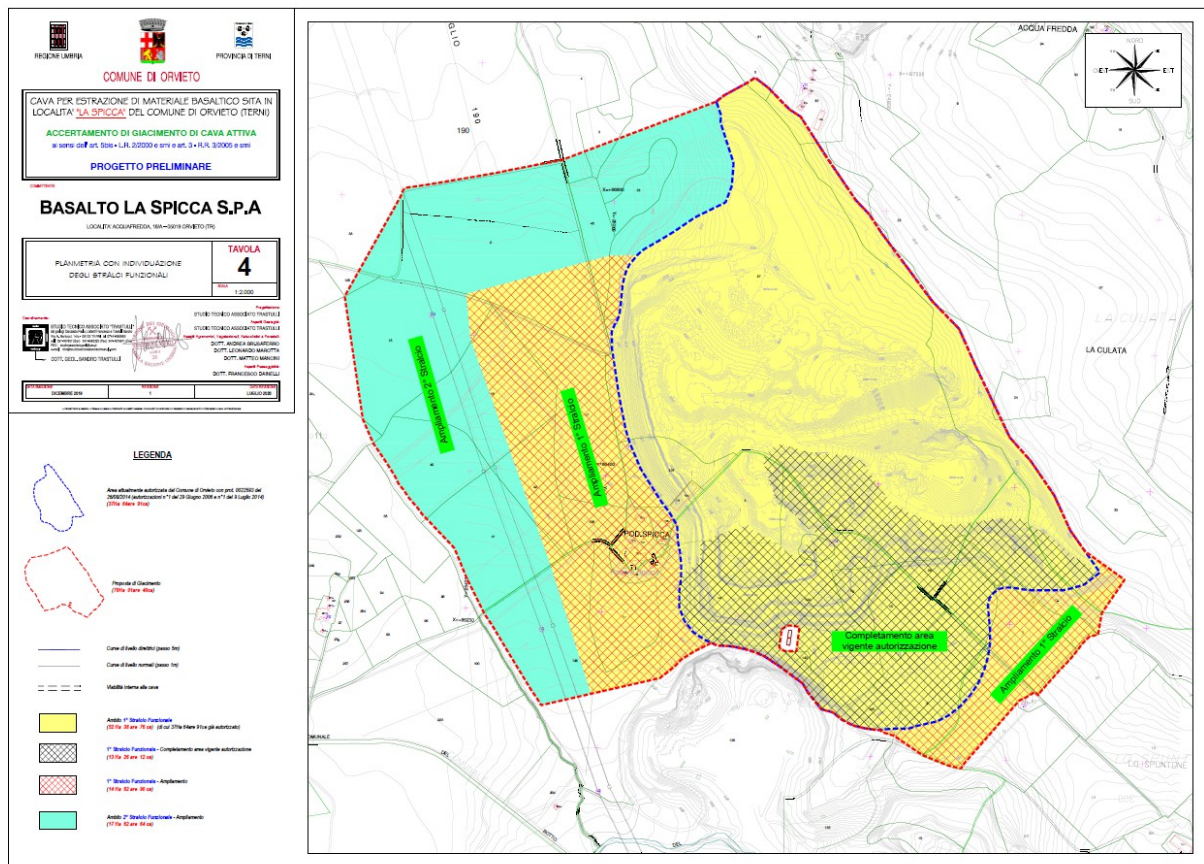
stralcio Tav.4 progetto Preliminare – Planimetria con indicazione degli stralci funzionali
